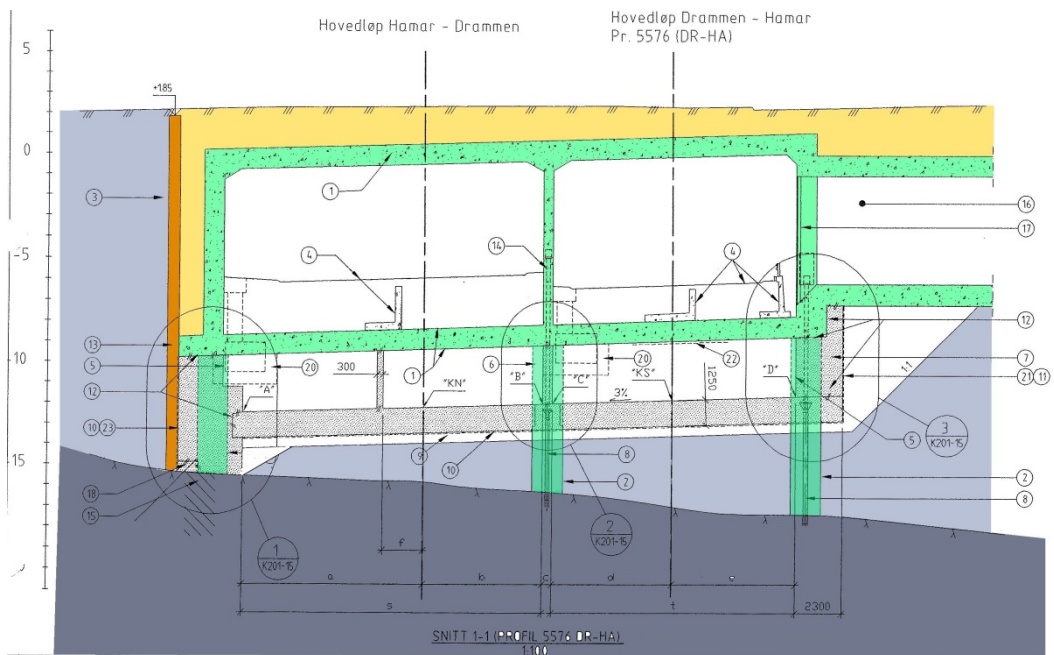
Utgraving under Festningstunnelen. Ny bunnplate støpt og fundamentert
